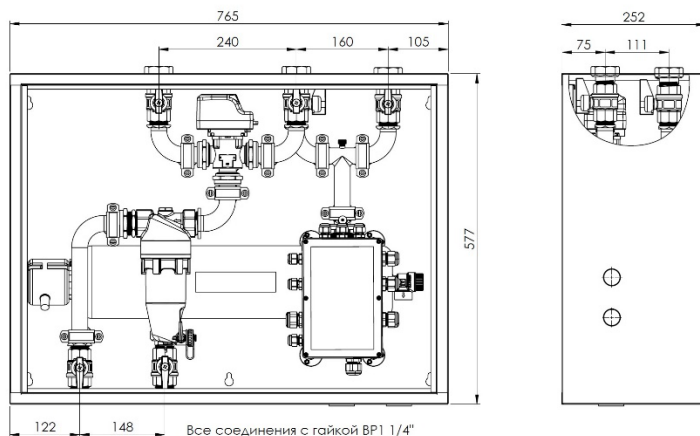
Размеры гидравлического набора AMB 900 и его соединений [мм]
